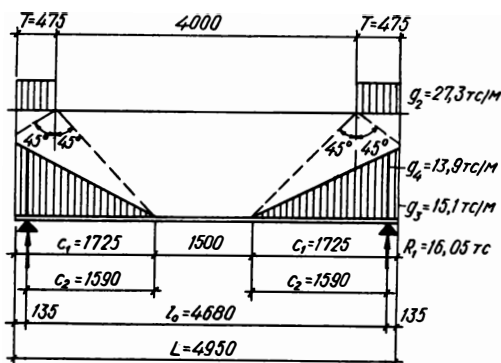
Расчетная схема фундаментной балки для 2-го случая загрузки.
